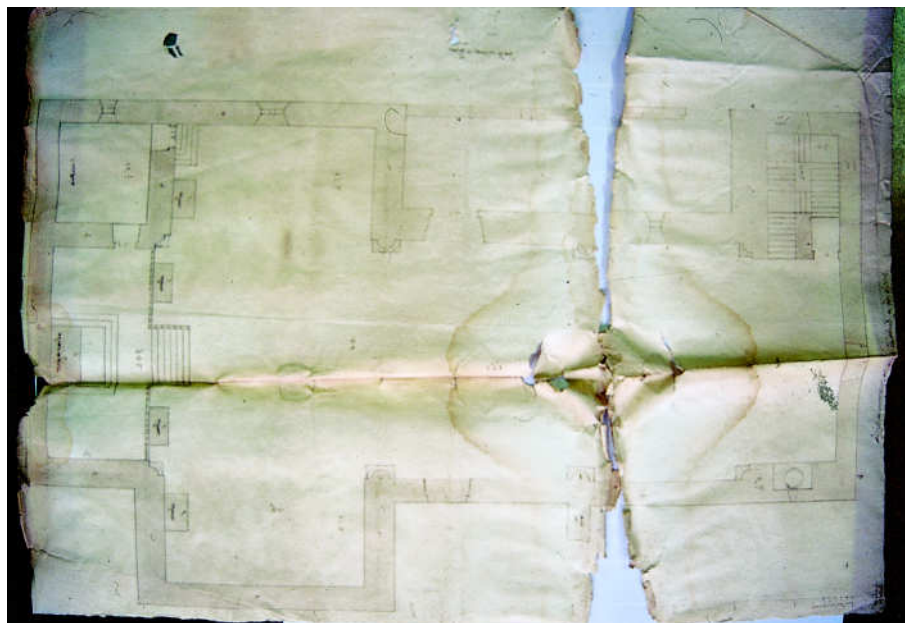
Francisco de Landa. Planta y alzado para la parroquia de Alegría.
